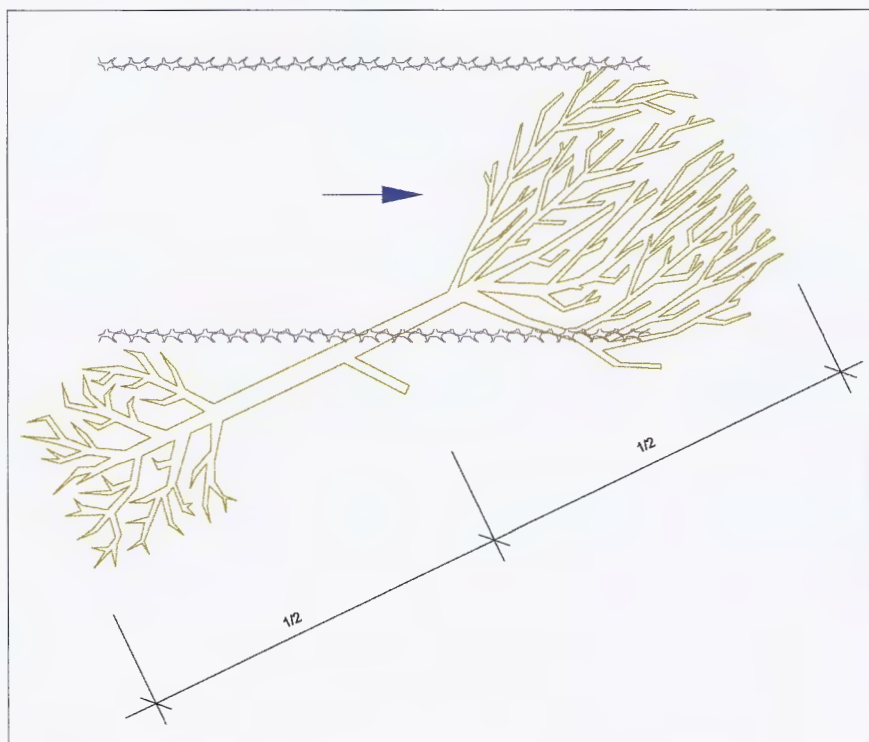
Variante 6 – Draufsicht (Quelle: IB Holzem & Hartmann)
